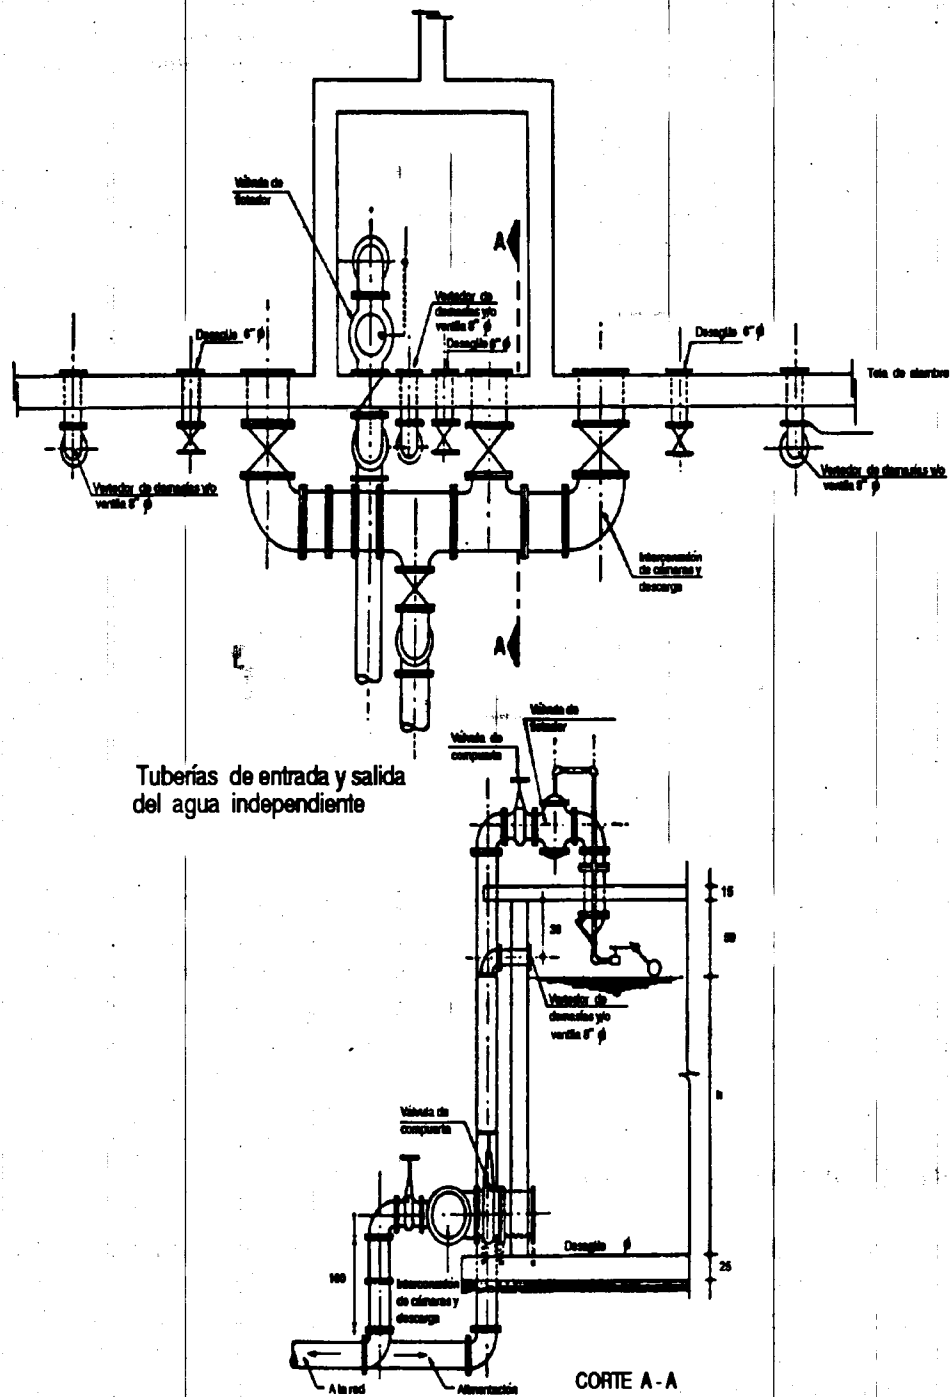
Arreglo de las tuberías de entrada y salida en un tanque.
